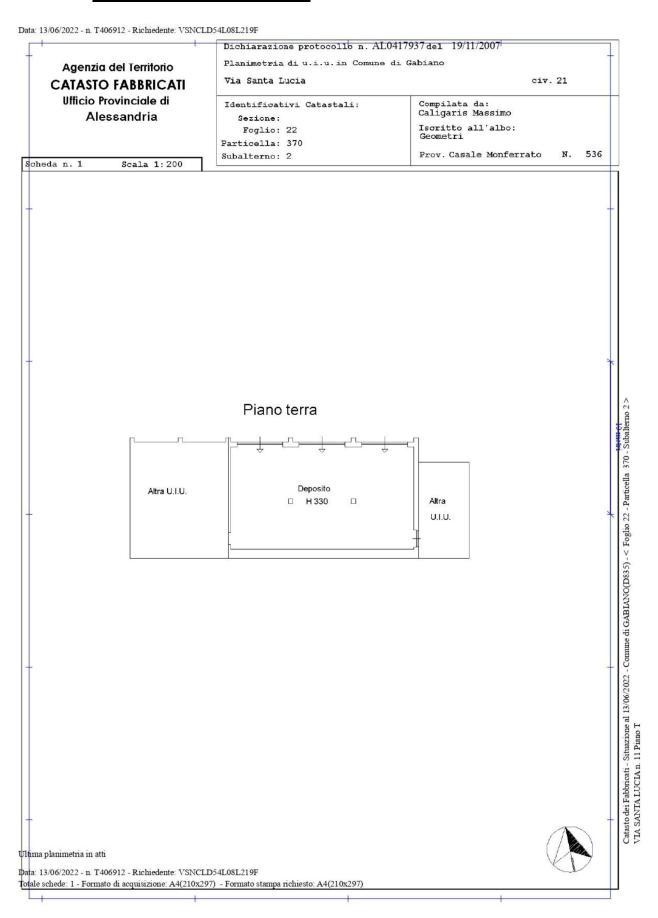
Accesso dal Cortile a Deposito in Piano Terra.
